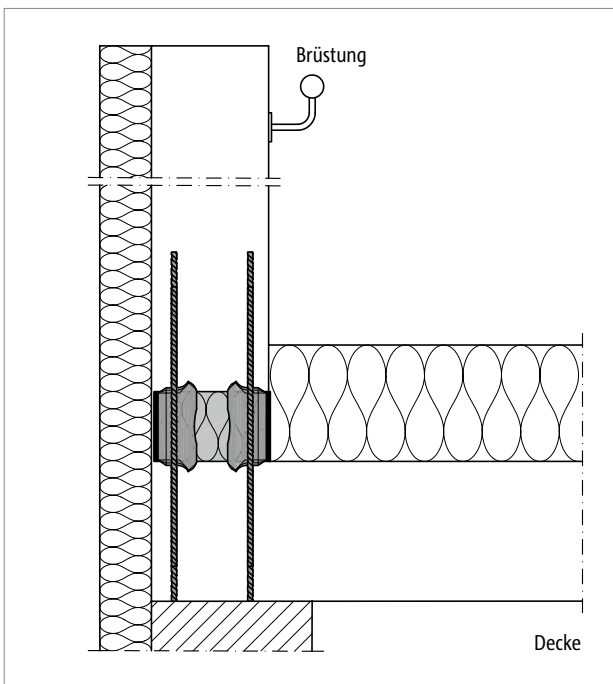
Schöck Isokorb® CXT Typ A: Anschluss einer Brüstung
